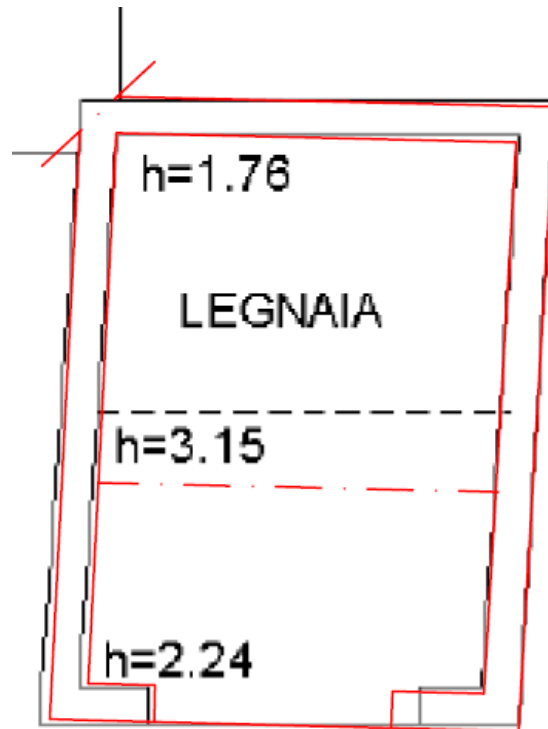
Sovrapposizione planimetria catastale – stato attuale p.lla 1949, p.1.
